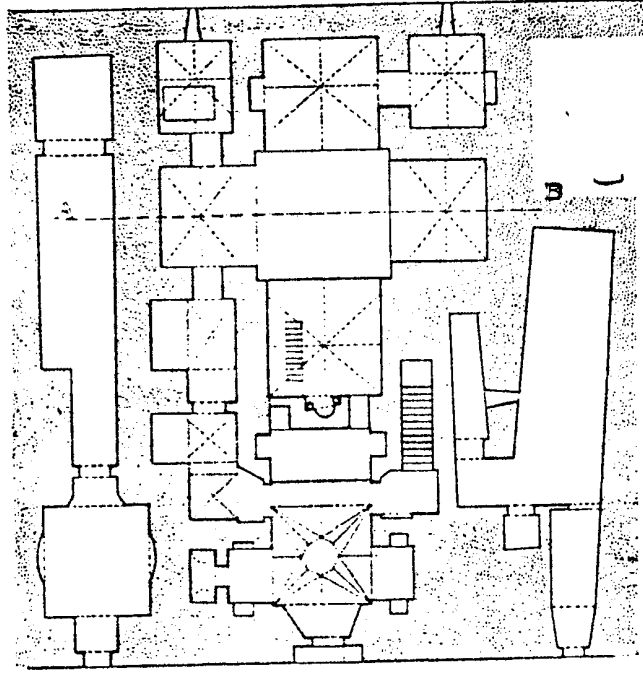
مسقط أفقي لجامع قجماس الأسحاقي بالقاهرة
